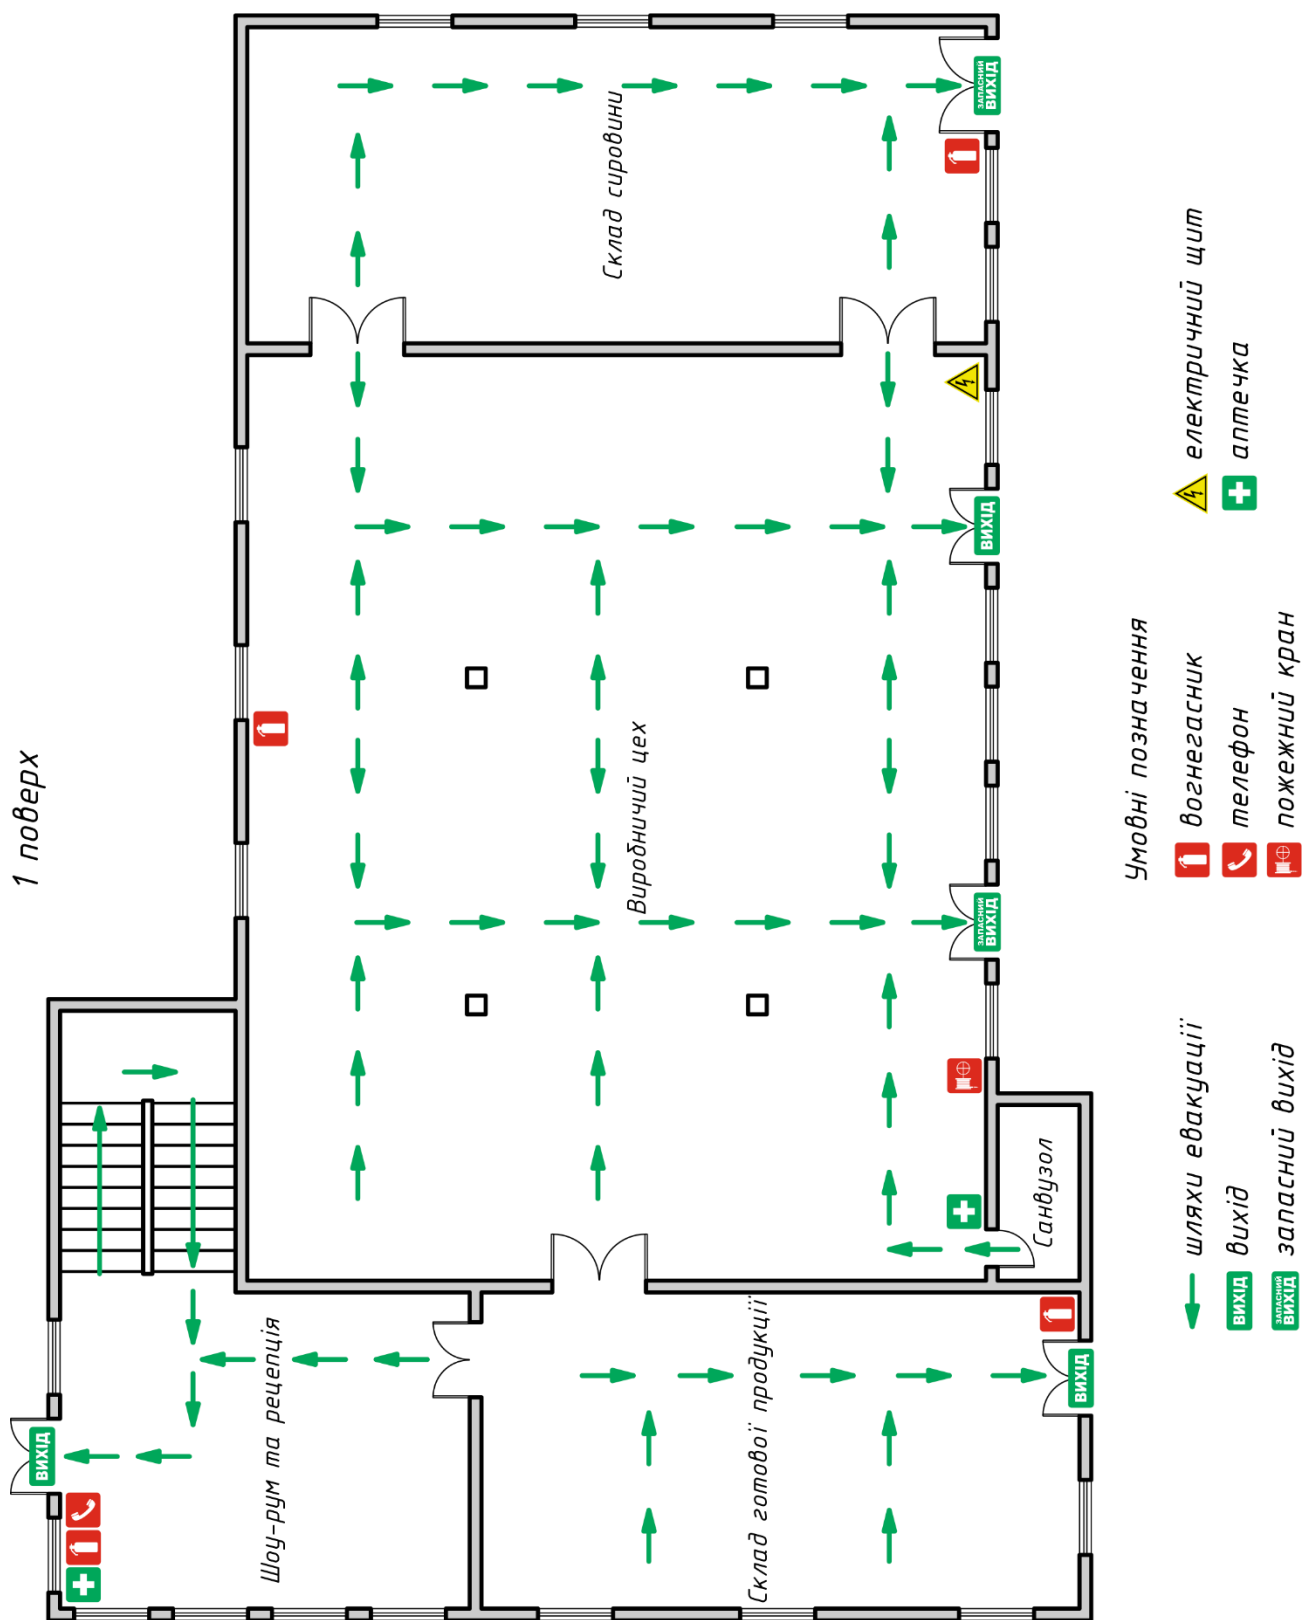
План евакуації із 1 поверху будівлі на випадок пожежі
